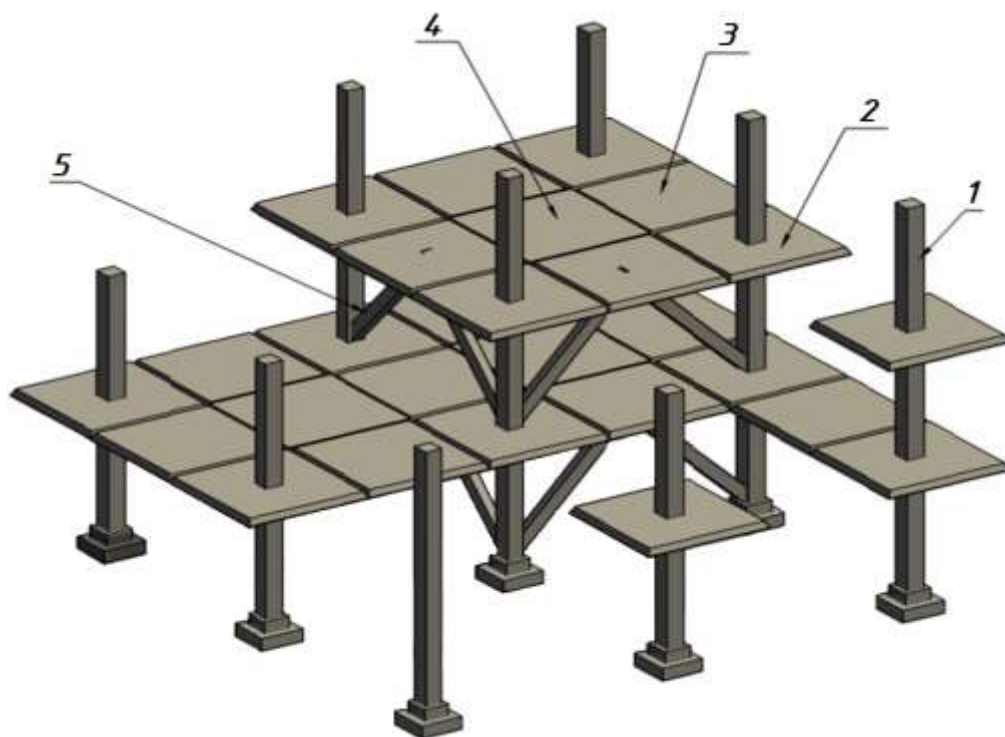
Конструкція залізобетонного безкапітельно-безбалкового збірного каркаса будівлі: 1 – колона; 2 – надколонна плита; 3 – міжколонна плита; 4 – середня плита; 5 – вертикальна в'язь
